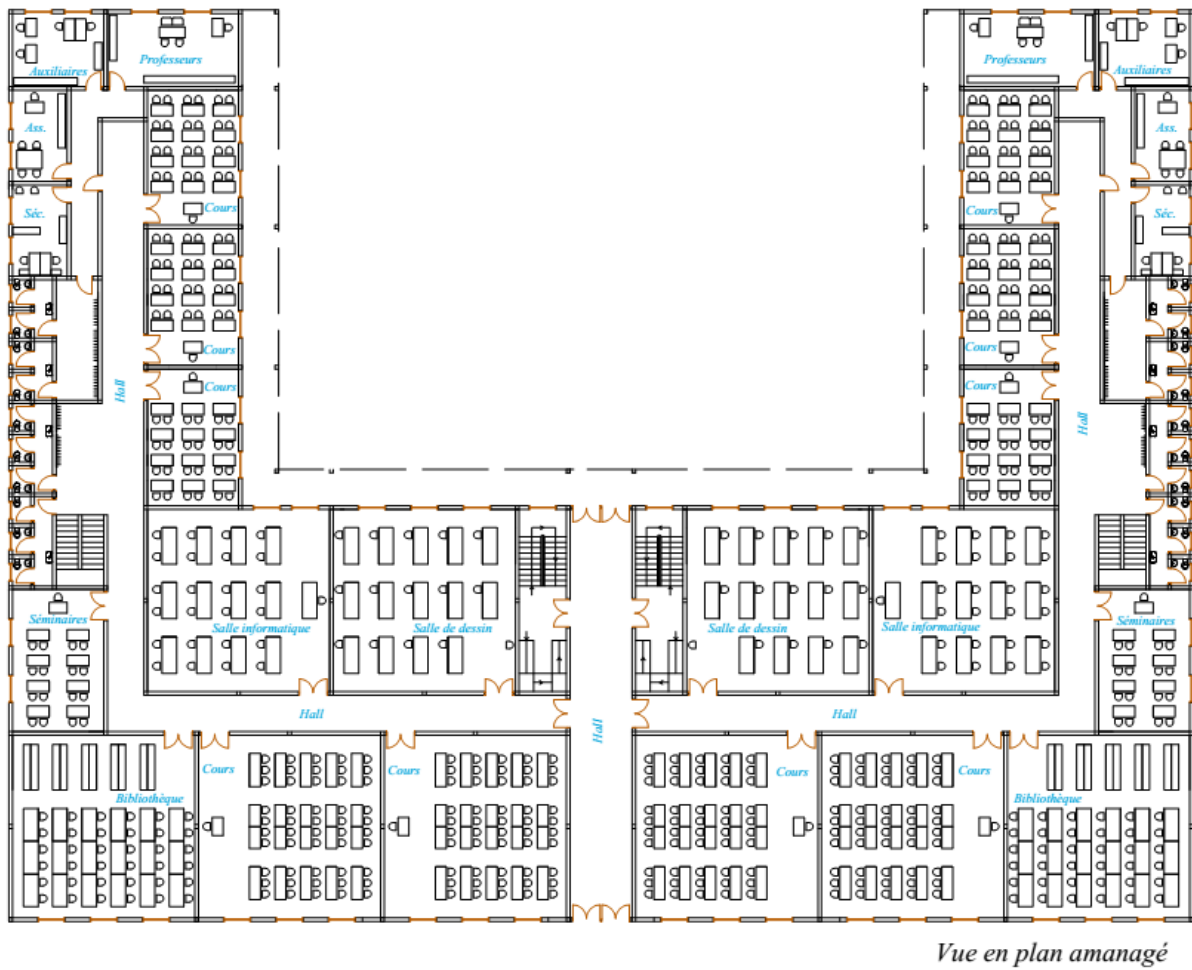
Plan annoté 2 ; Echelle 1/500
